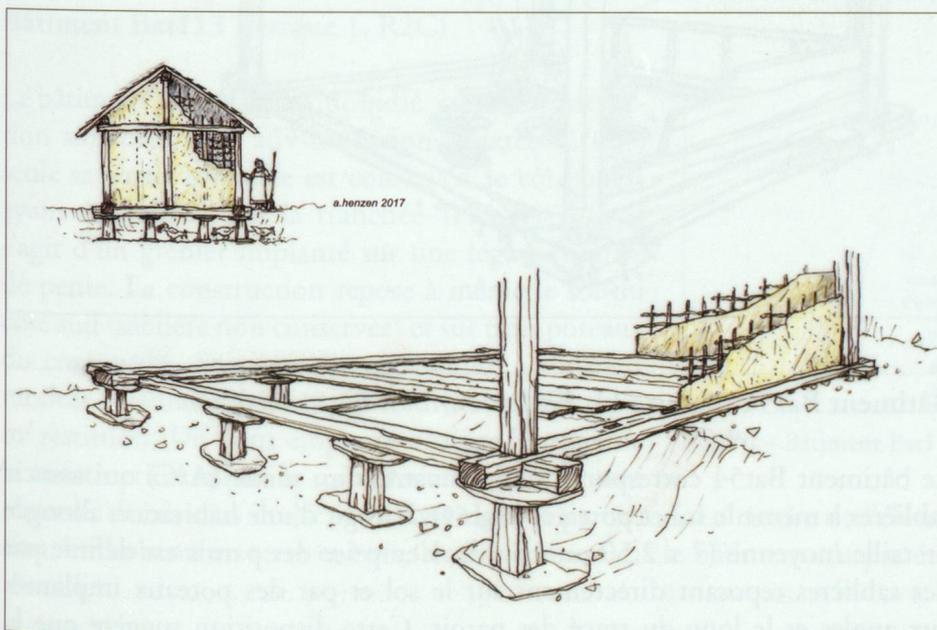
Bâtiment Bat131. Reconstitution de l'architecture de la construction. Dessin Andreas Henzen.
